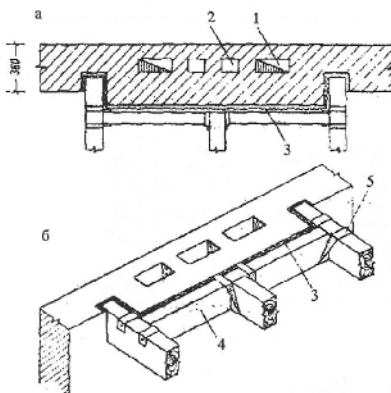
Дымовые и вентиляционные каналы: а, б – размещение каналов в стенах план (а) и общий вид (б); 1 – дымоход; 2 – вентиляционные каналы; 3 – изоляция; 4 – ригель; 5 – хомут
